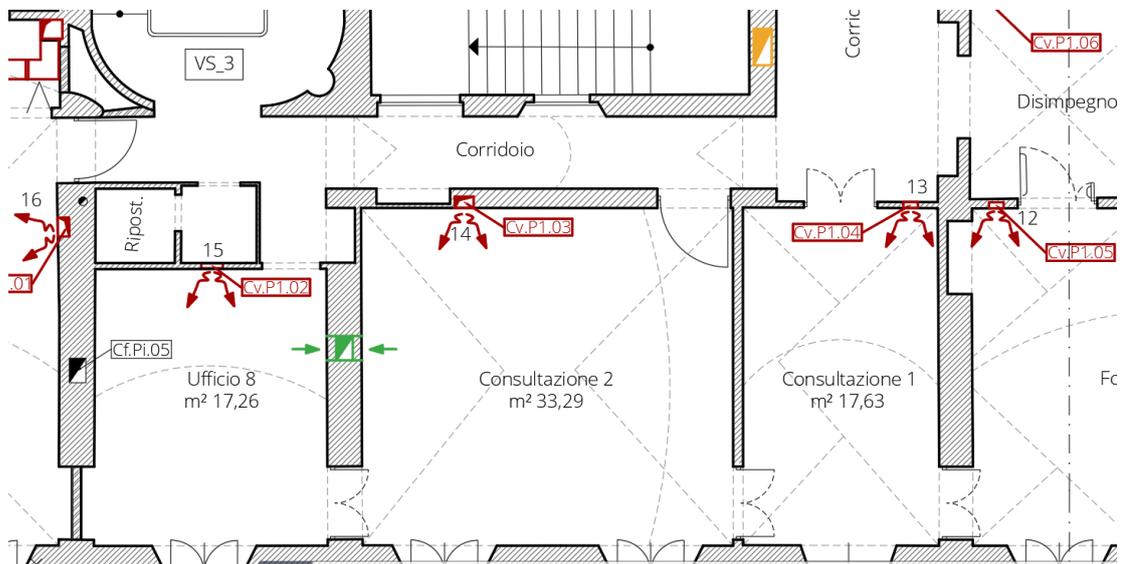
Estratto della pianta del piano 1 in cui sono visibili le posizioni delle bocchette di ventilazione del vecchio sistema di ventilazione.
